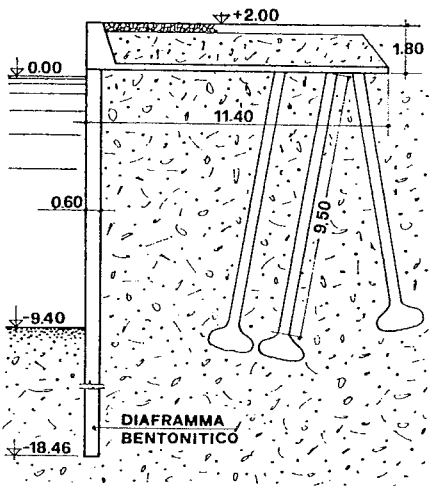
Banchina con diaframma bentonitico nel porto di Ravenna.
